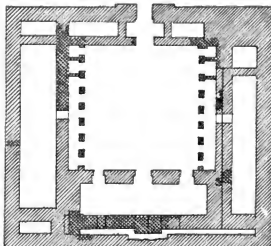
Grundriß des Festhauses bei Assur, späterer Bestand
